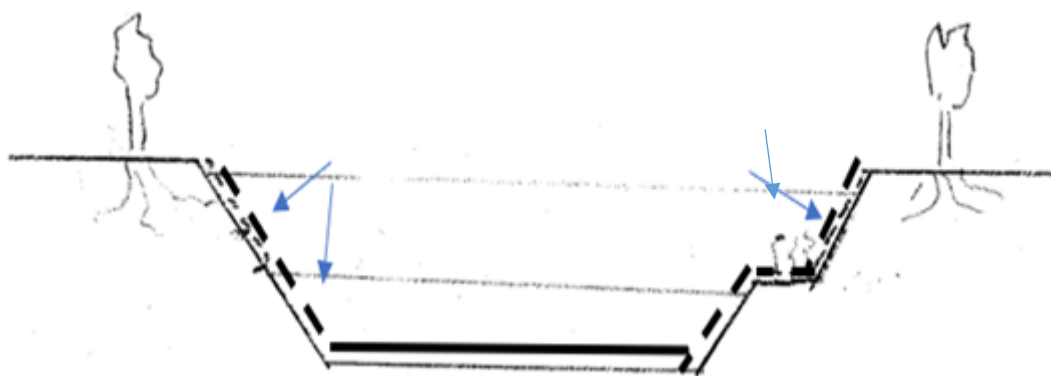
[Пример]: Частично бетонный мат Ceiling (защита насыпей и нижний сплошной бетонный потолок)
